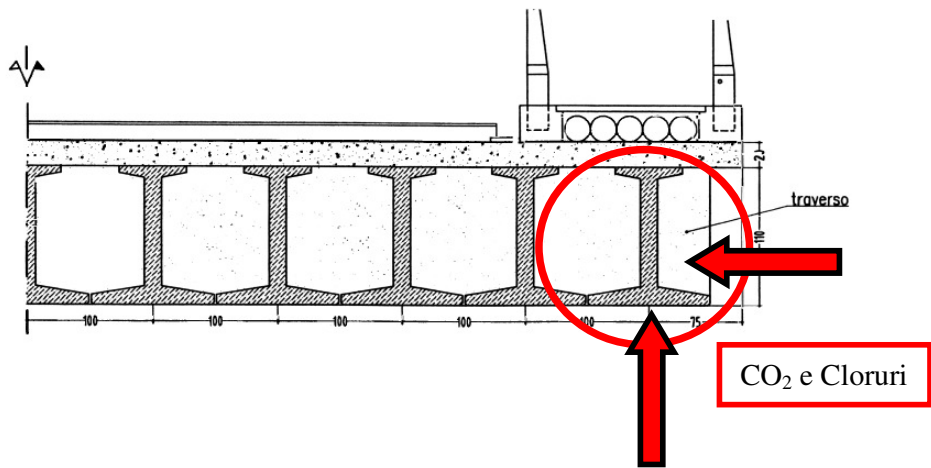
Descrizione dell'impalcato e definizione della trave in calcestruzzo armato precompresso soggetta a degrado.
